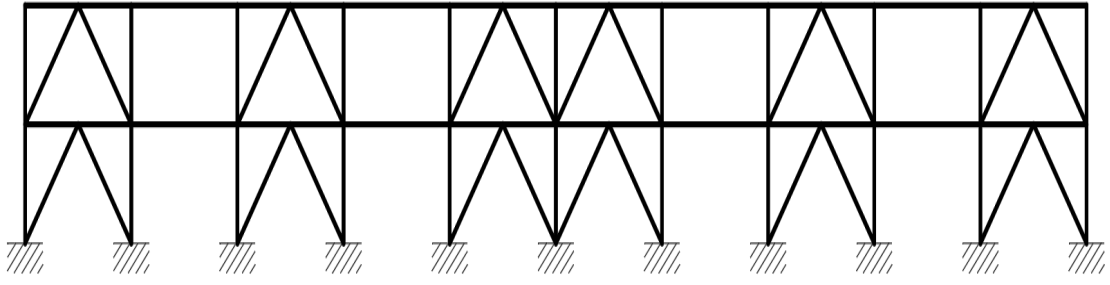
Çapraz, kolon ve deprem kirişleri detayı.
